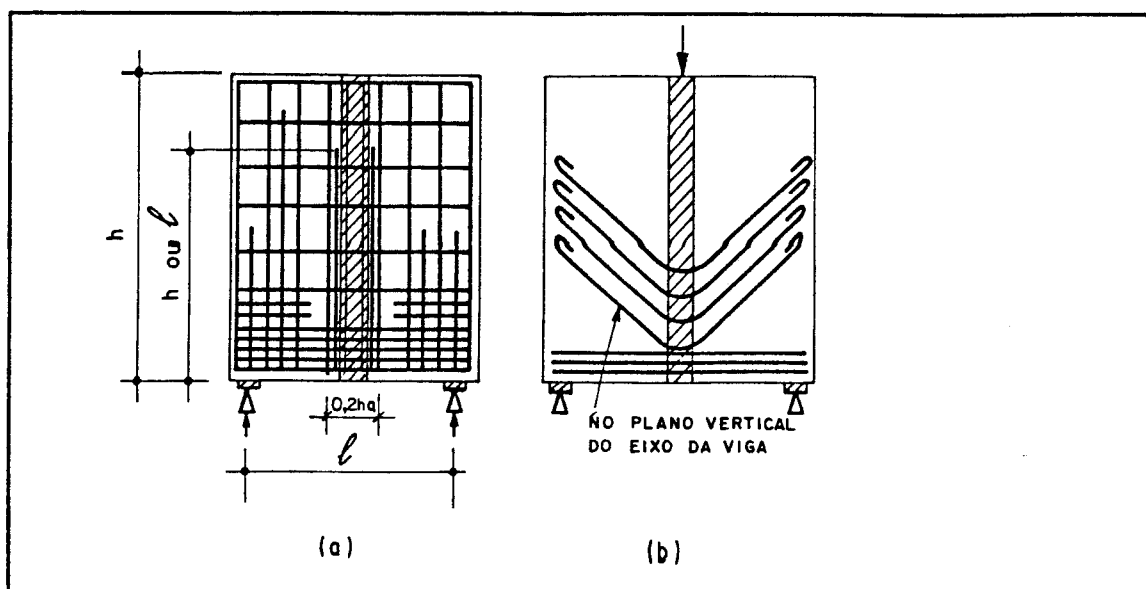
Armadura para ação aplicada ao longo da altura: a) estribos verticais, b) barras dobradas (Ref. 6).
